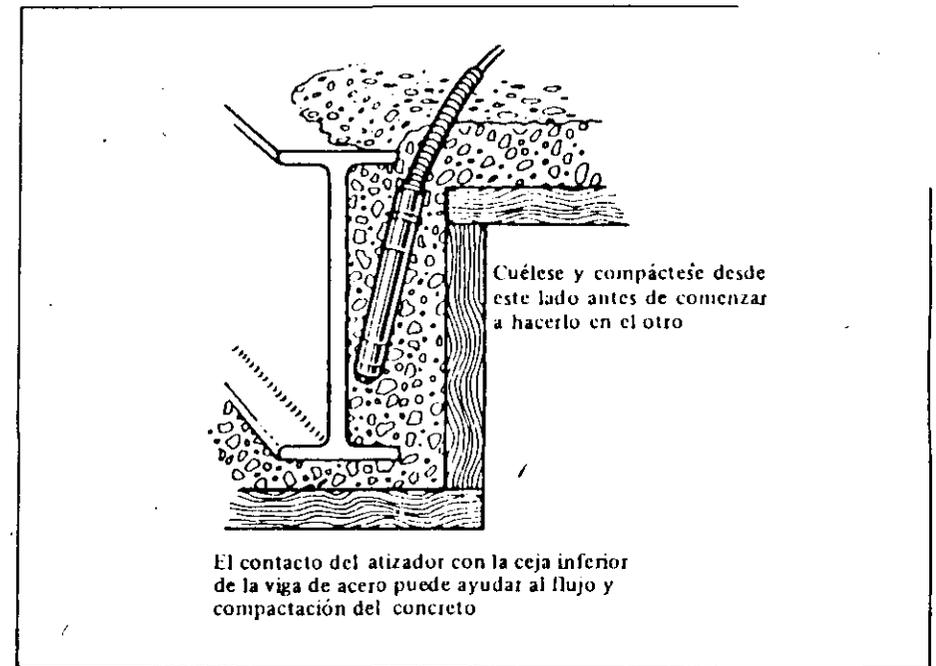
Técnica para colar y compactar concreto alrededor de una viga de acero.
